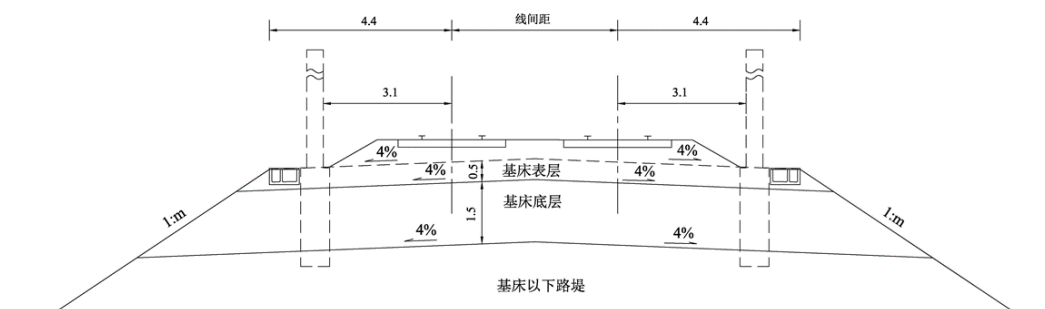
路肩设电缆槽有砟轨道双线路基横断面图 (单位: m)
